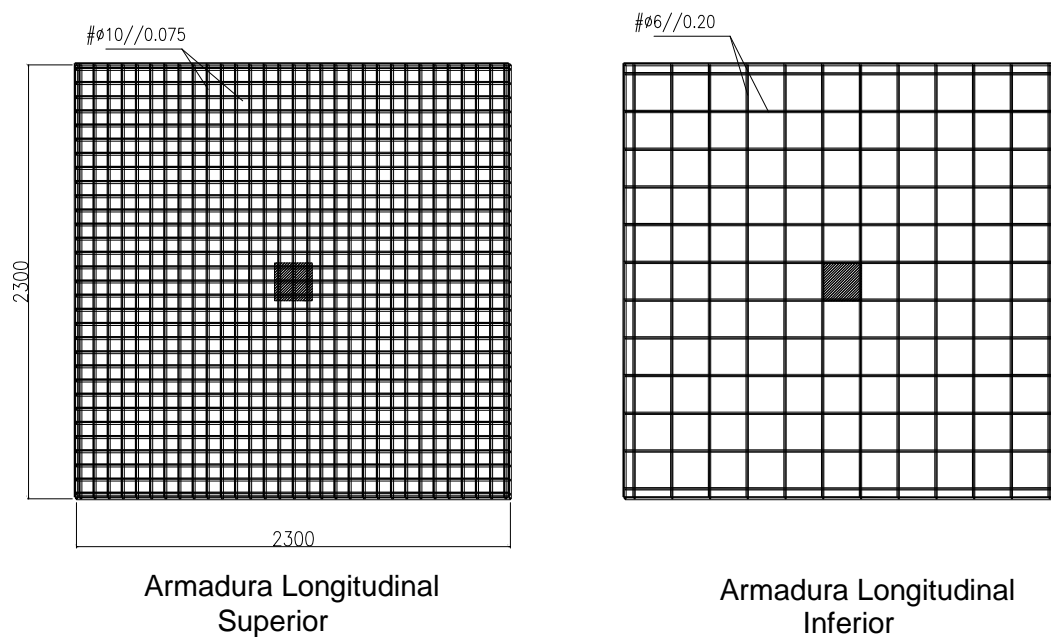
Armaduras longitudinais dos modelos DF4 a DF7 (desenho sem escala e dimensões em mm).
